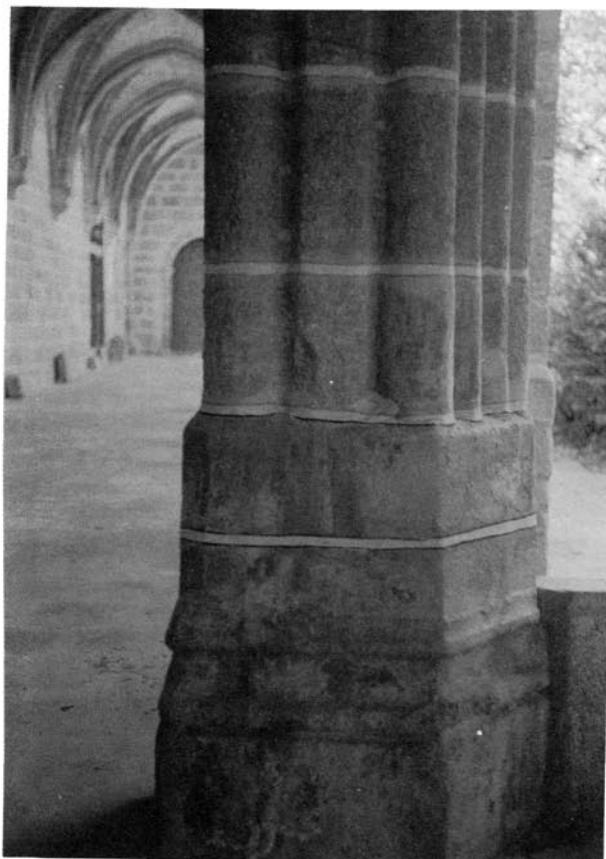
Pilar de núcleo prismático y columnas en sus frentes.
